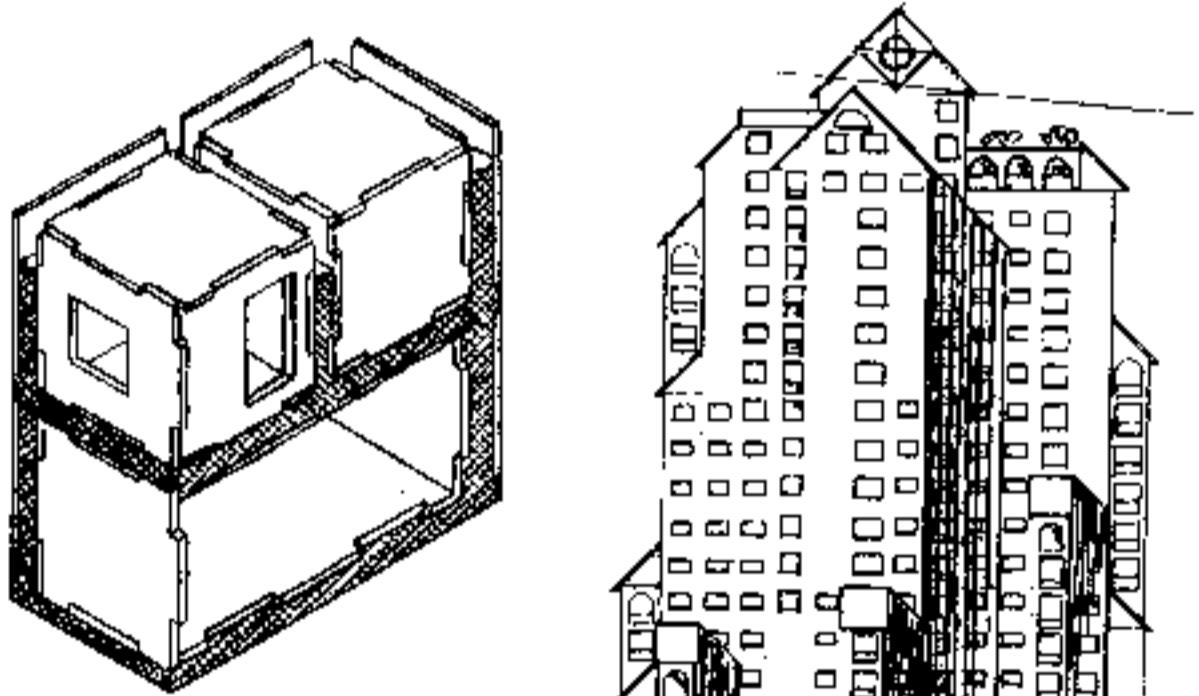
Фрагмент конструкции здания с помещением размером 6х6 м
